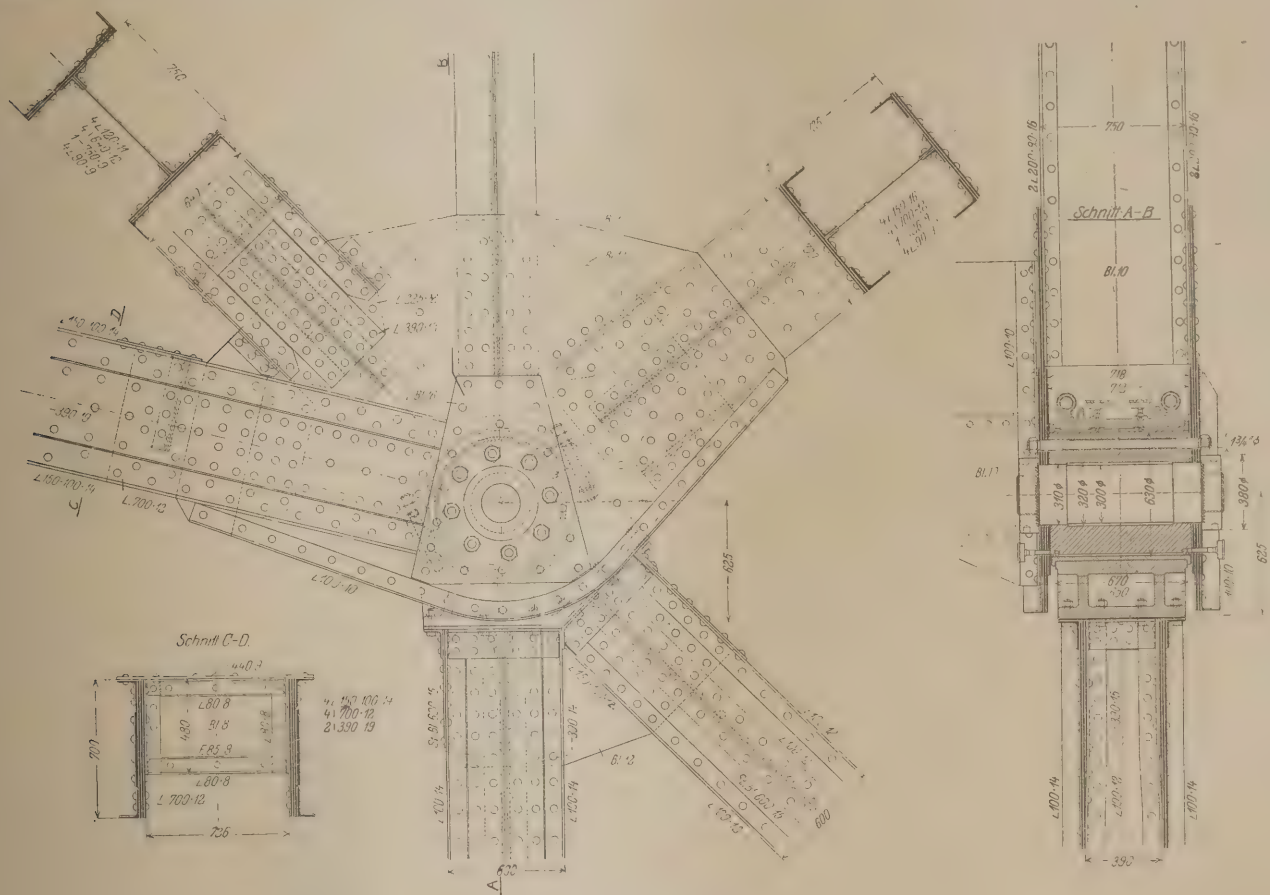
Verbindung des Wagebalkens mit dem Stützbock.
